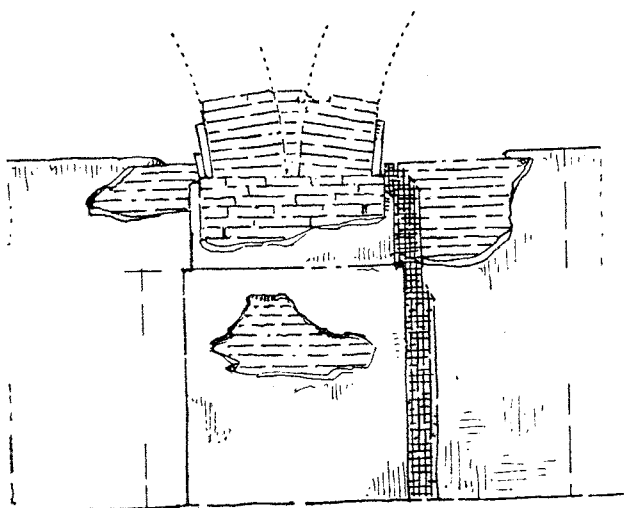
Pilastro del portico scoperto sul Monte Giulio.
